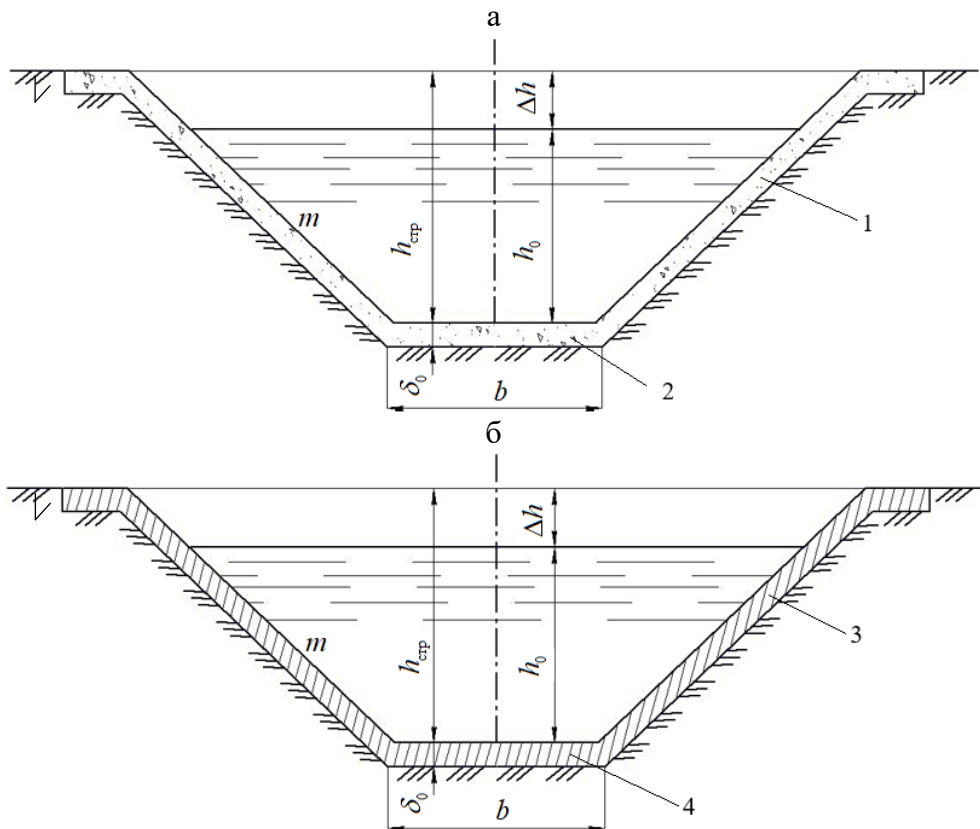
Схемы сечений оросительного канала с бетонными облицовками, лист 1
